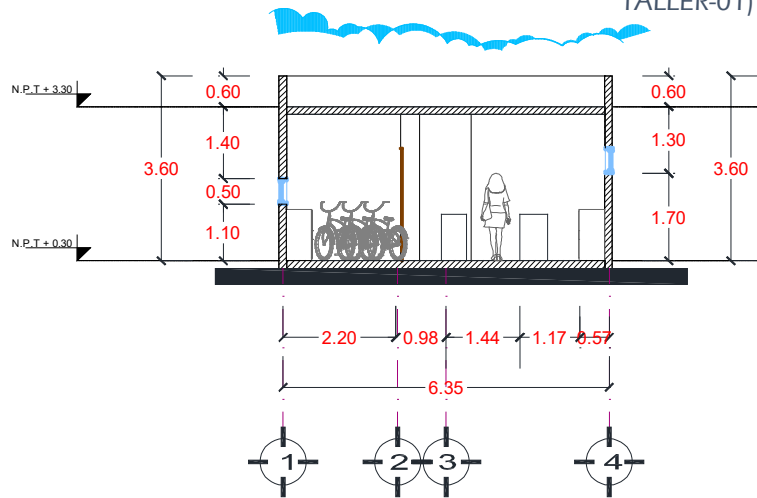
Propuesta Taller, Sección A-A (Anexos Plano: 10- FACH-TALLER-01)
